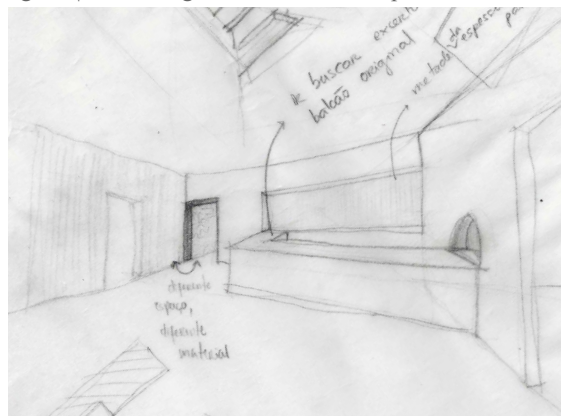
e 263| Opção com balcão longitudinal e encostado à parede divisória
